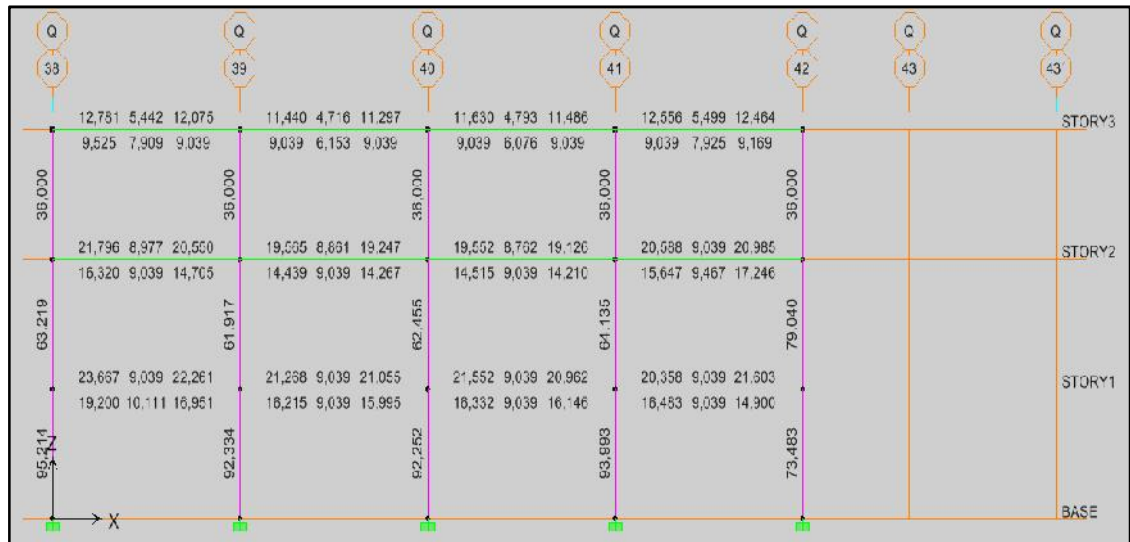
Acero en vigas pórtico Q, Consulta Externa I
